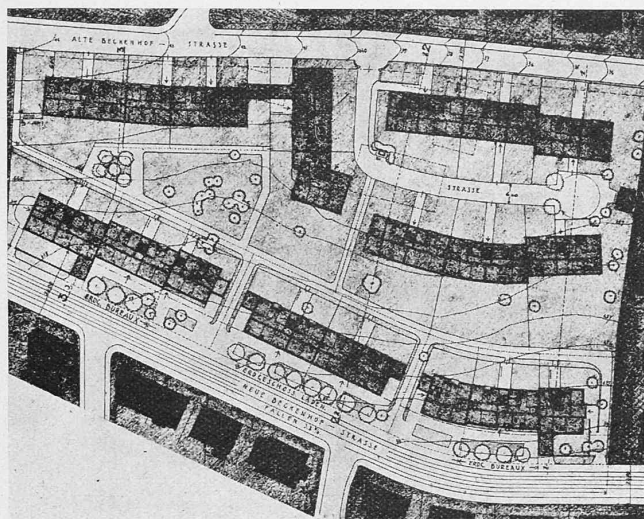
Entwurf Nr. 2. Lageplan 1:2000 ohne altes Haus.
